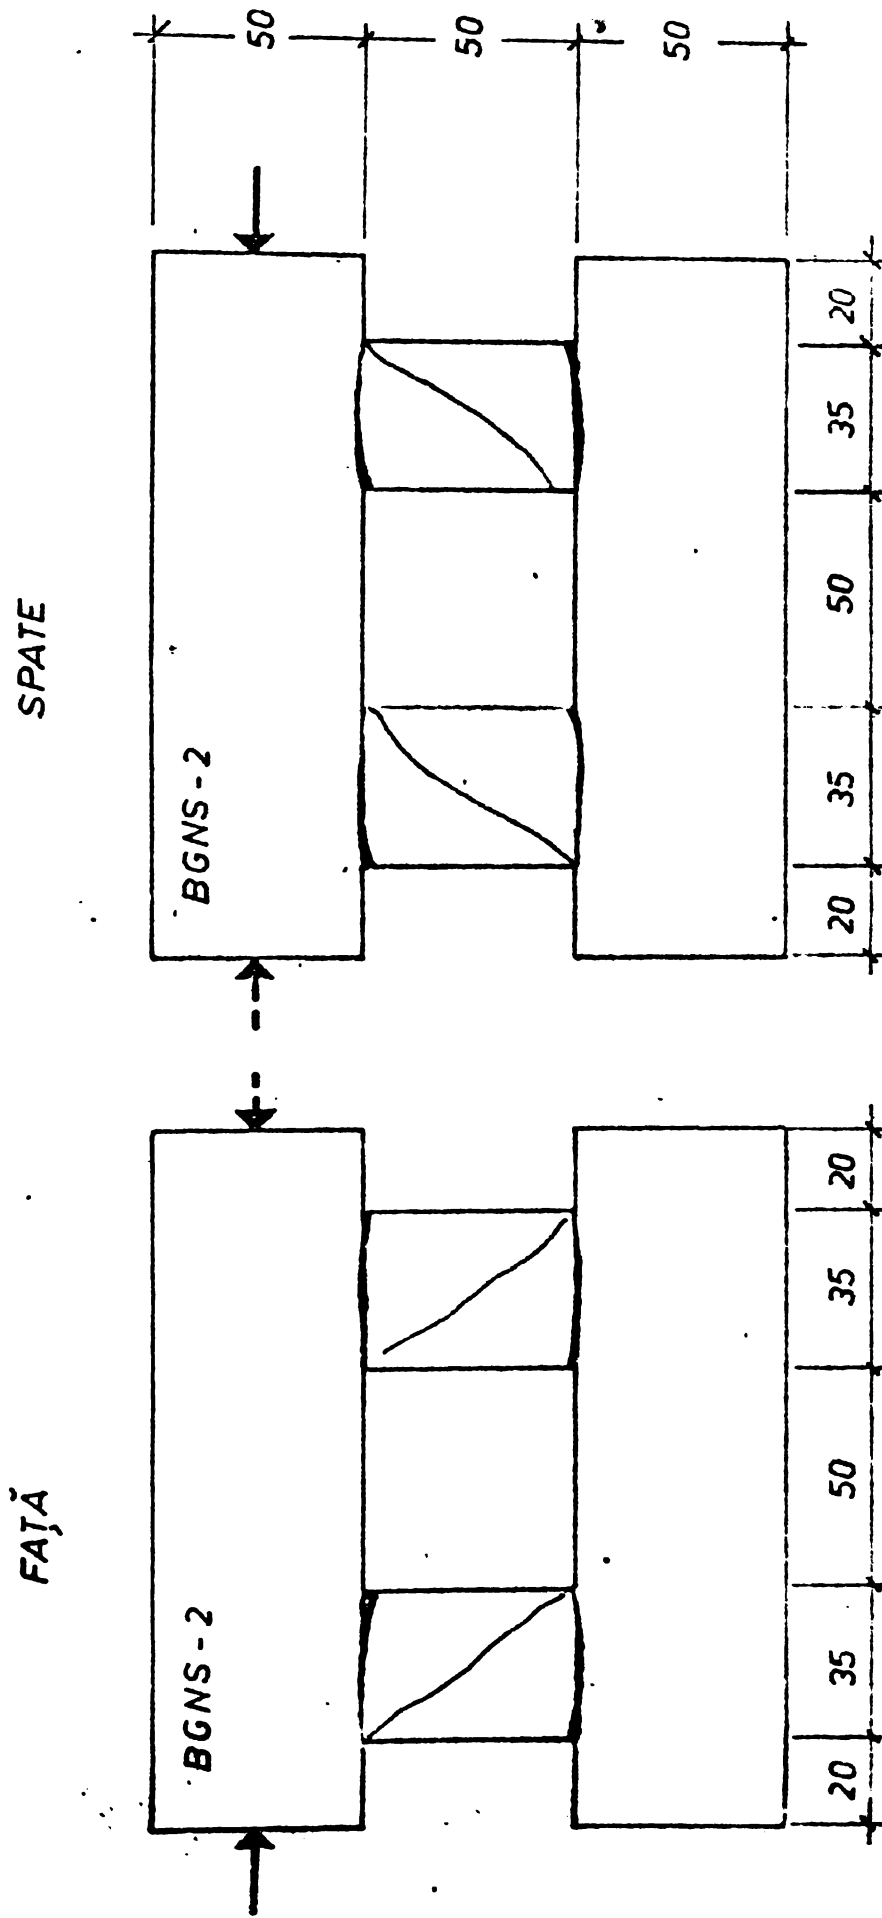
MODUL DE FISURARE A BUIANDRUGILOR ELEMENTULUI BGNS - 2 LA RUPERE
